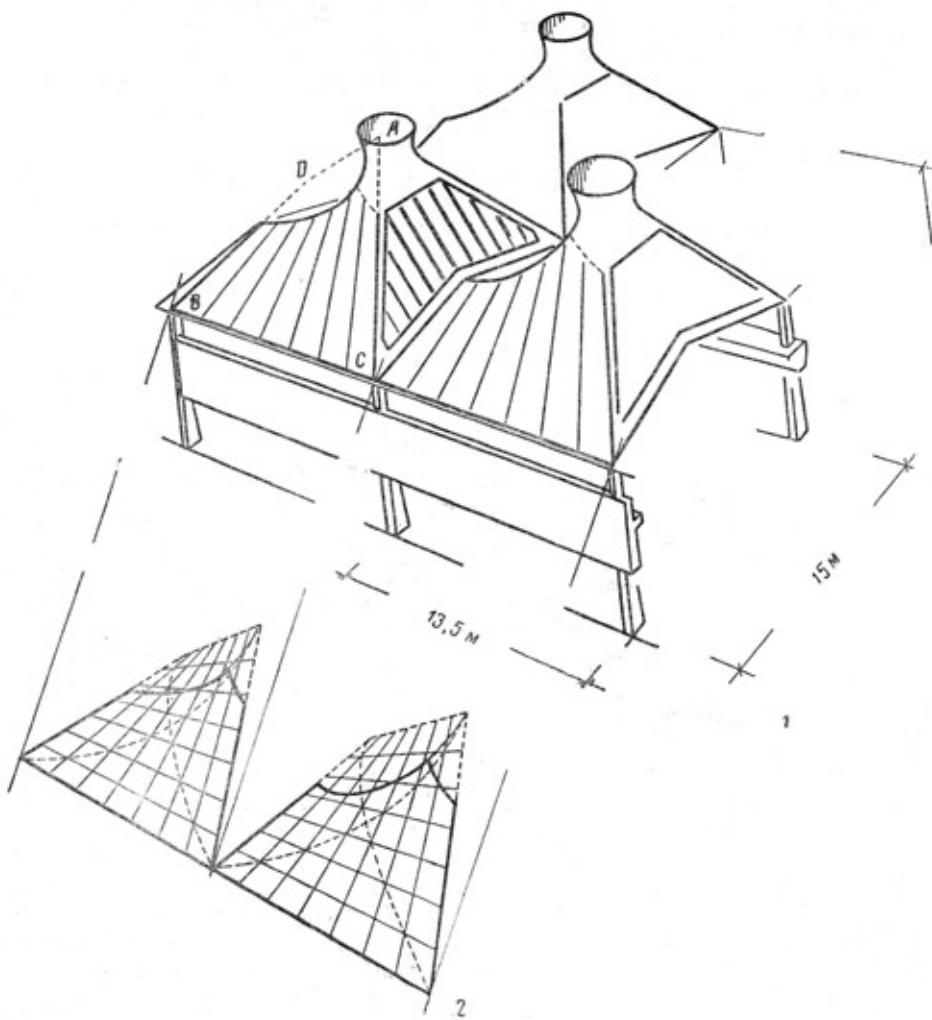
Железобетонное покрытие литьевого цеха в Лоре-на-Майне
